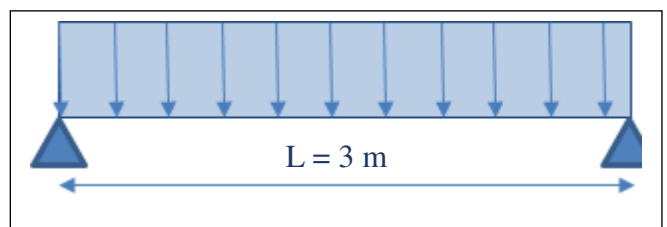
Schéma statique de la poutrelle et son chargement avant coulage de la dalle.
